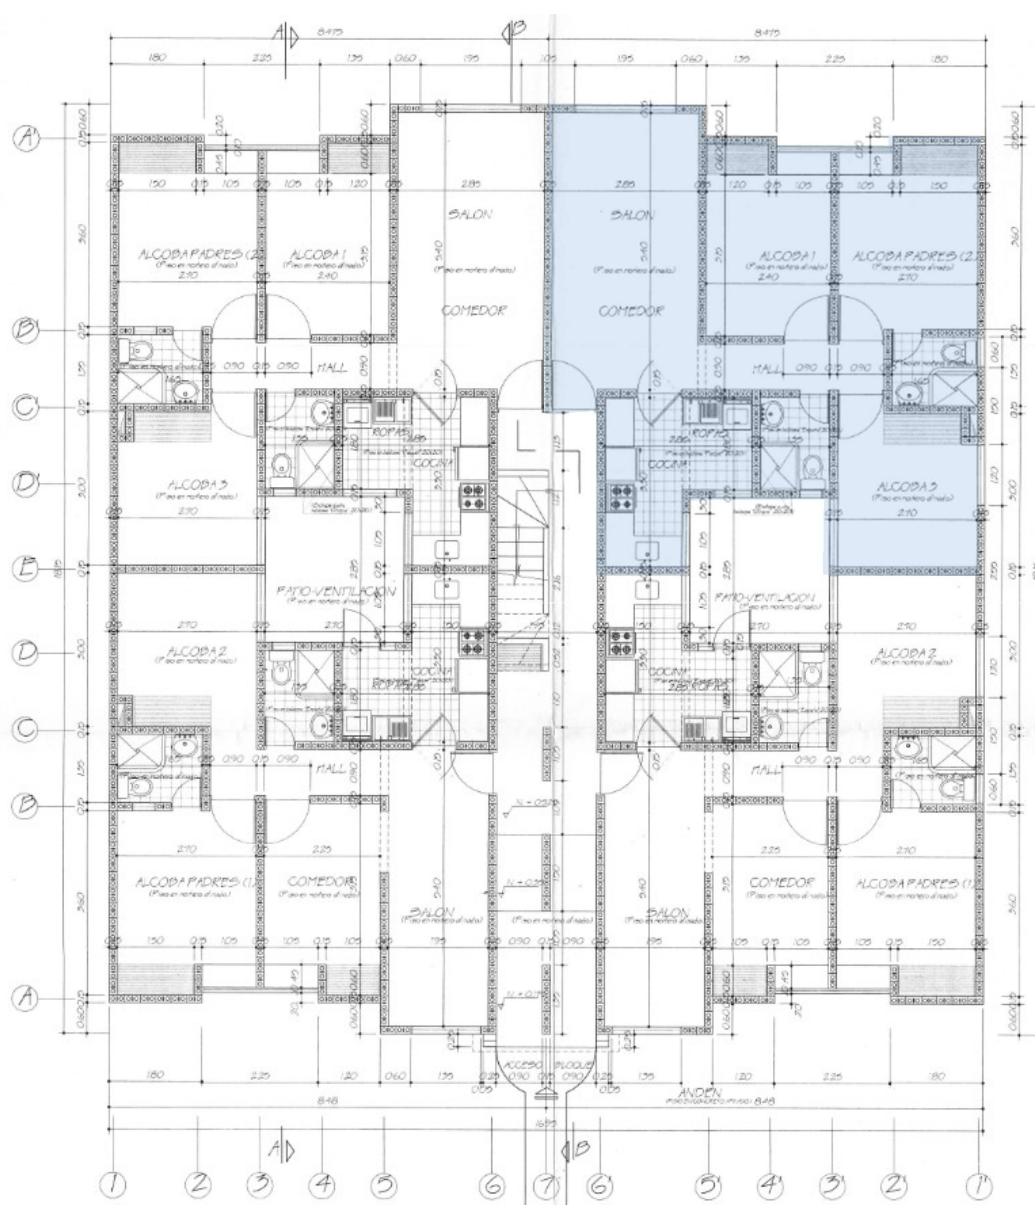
Planta arquitectónica planta Bloque 8, apto 104 afectado por explosión (Fuente. Plano arquitectónico 06).
